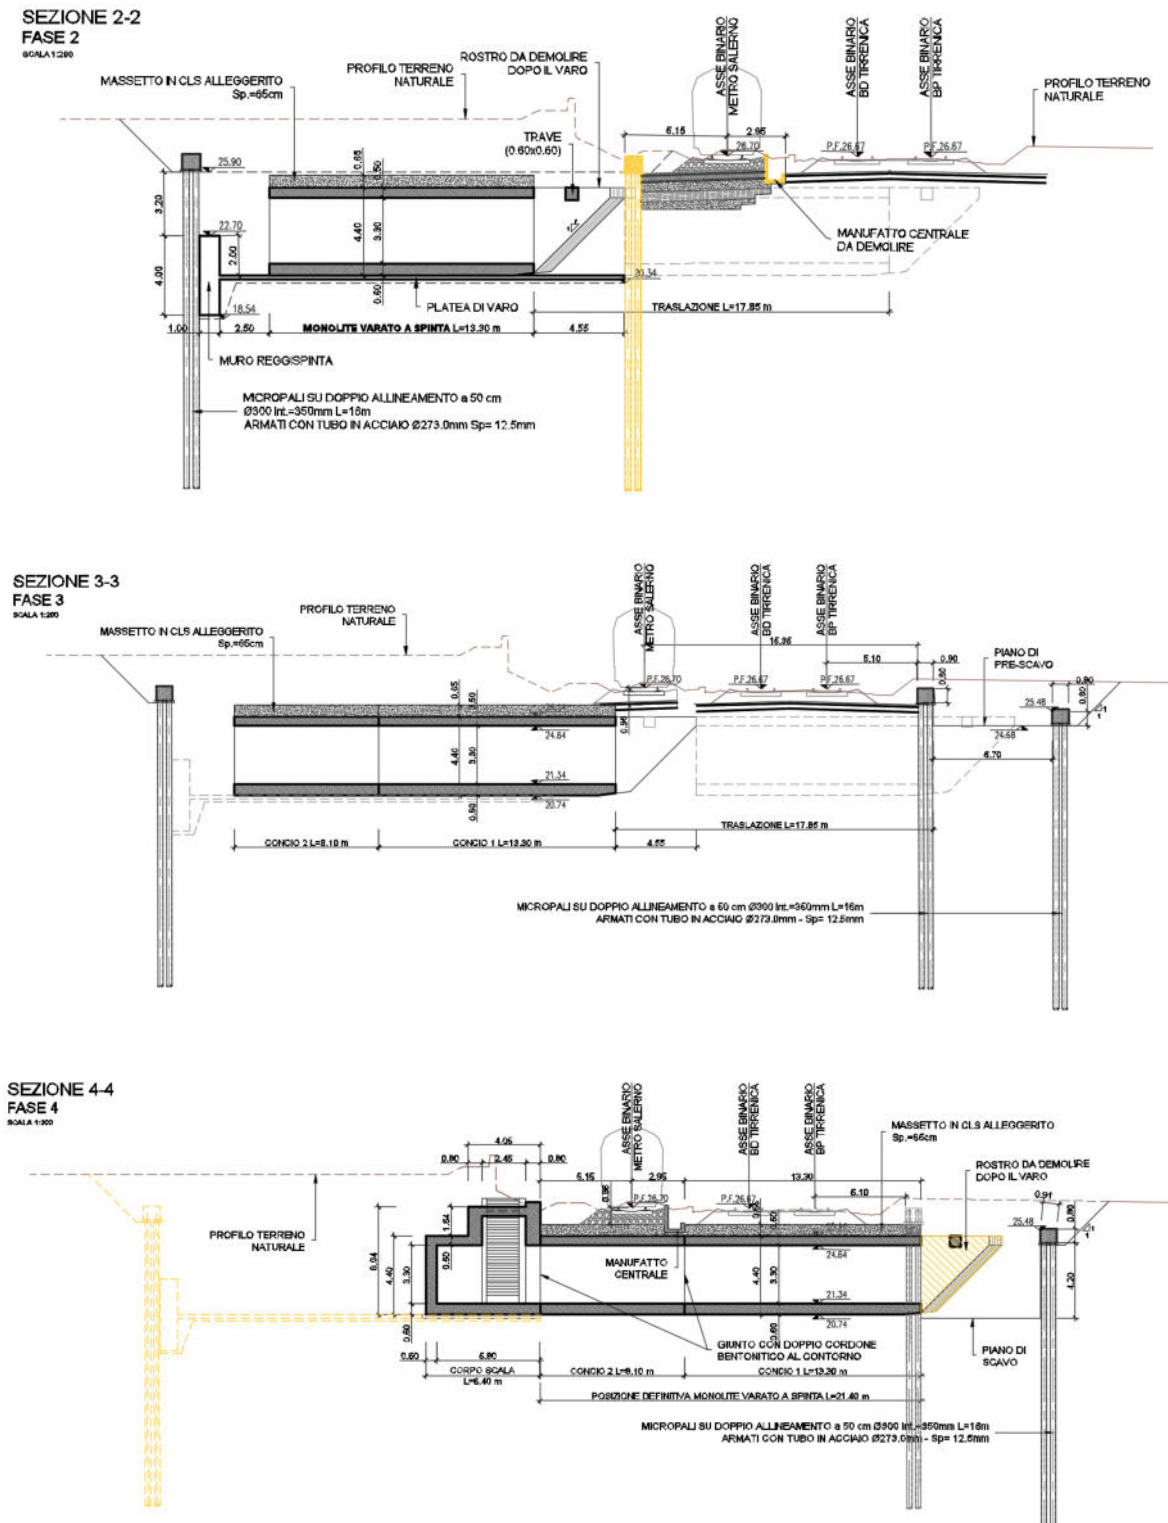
Sezione longitudinale monolite in posizione di varo e a varo ultimato
